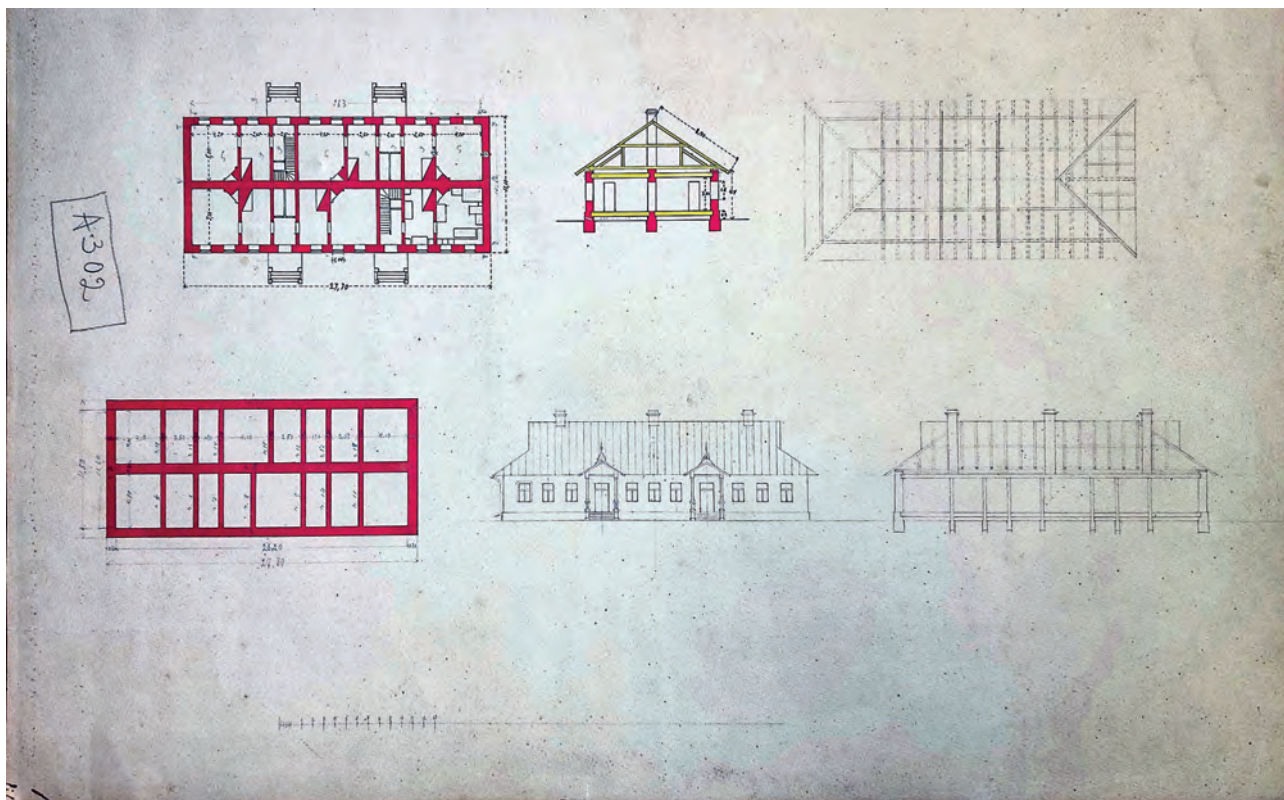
Мощенко К. Фасад та план одноповерхового будинку. 1910-20-ті рр.
